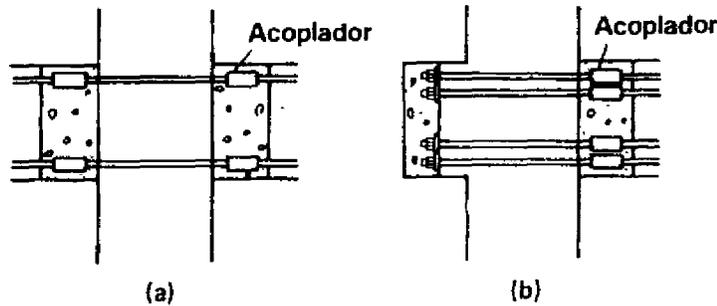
Conexión viga-columna. a) Concreto armado b) Concreto presforzado (Wakabayashi,1986)
